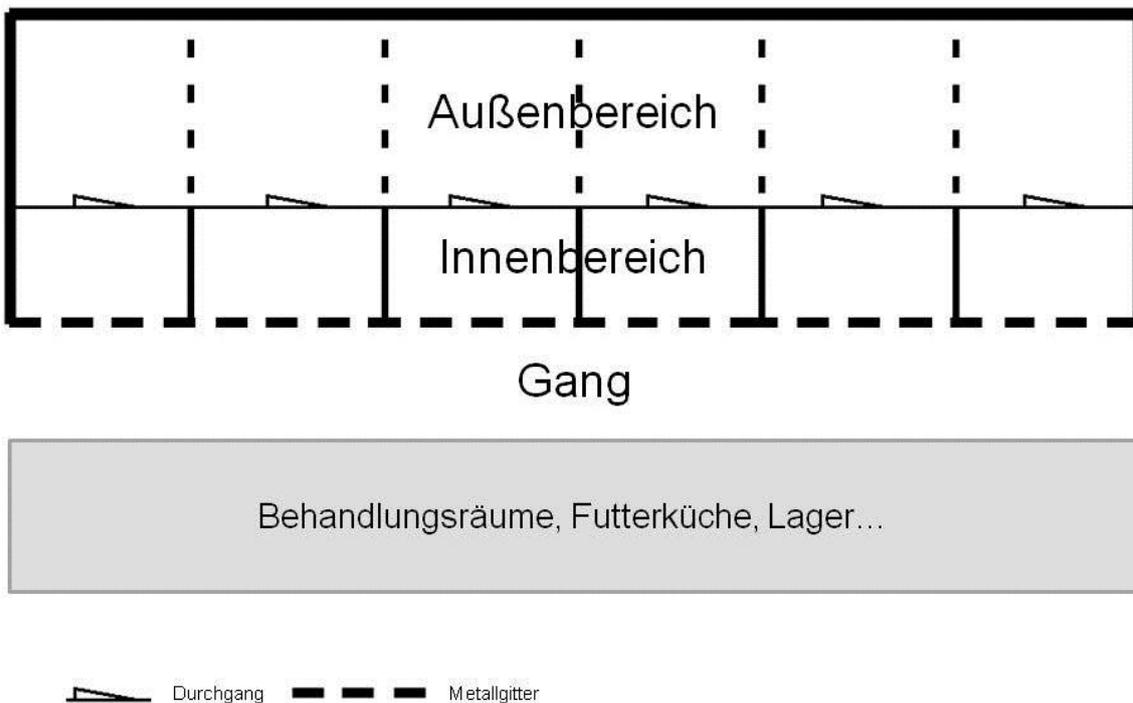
Grundriss (Ausschnitt) des Innen- und Außenbereichs der Einrichtung C unter der Berücksichtigung von feststehendem Enrichment und sichtdurchlässigem Material (Gitter)
